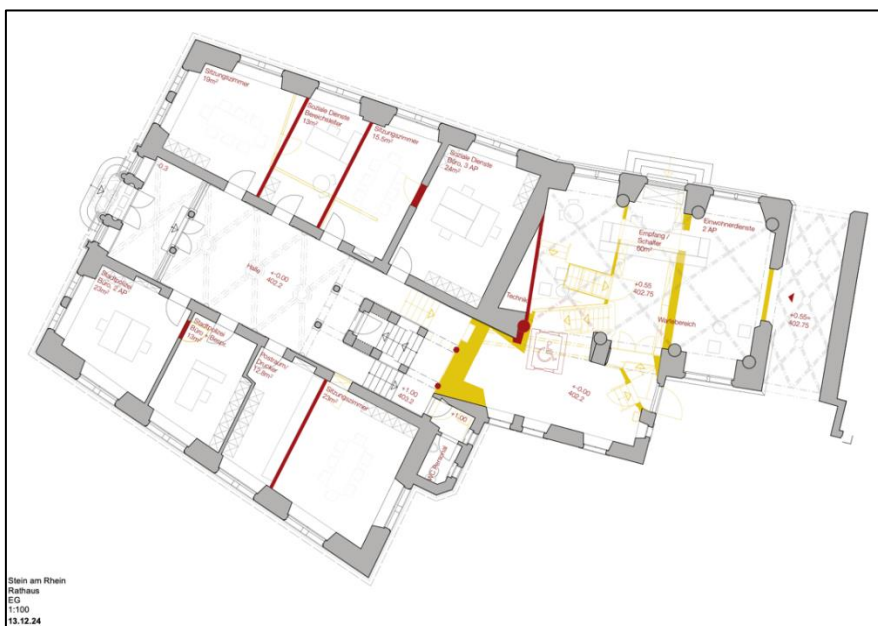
Offene, einladende Erdgeschossituation über beide Gebäude
